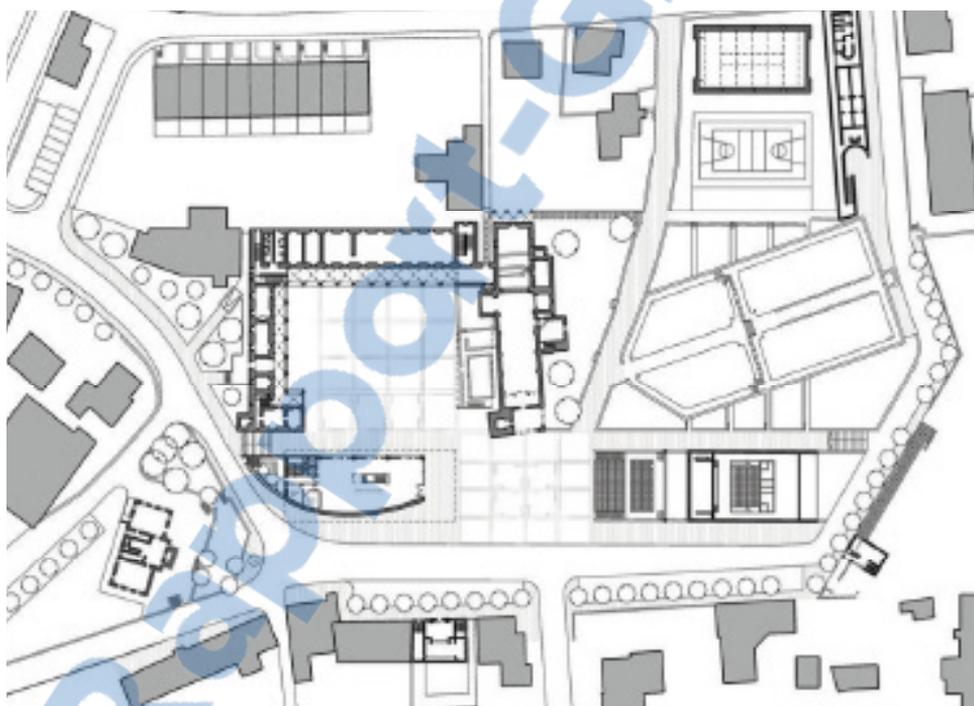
Plan du site de Monte Carasso - Arch. Luigi Snozzi
